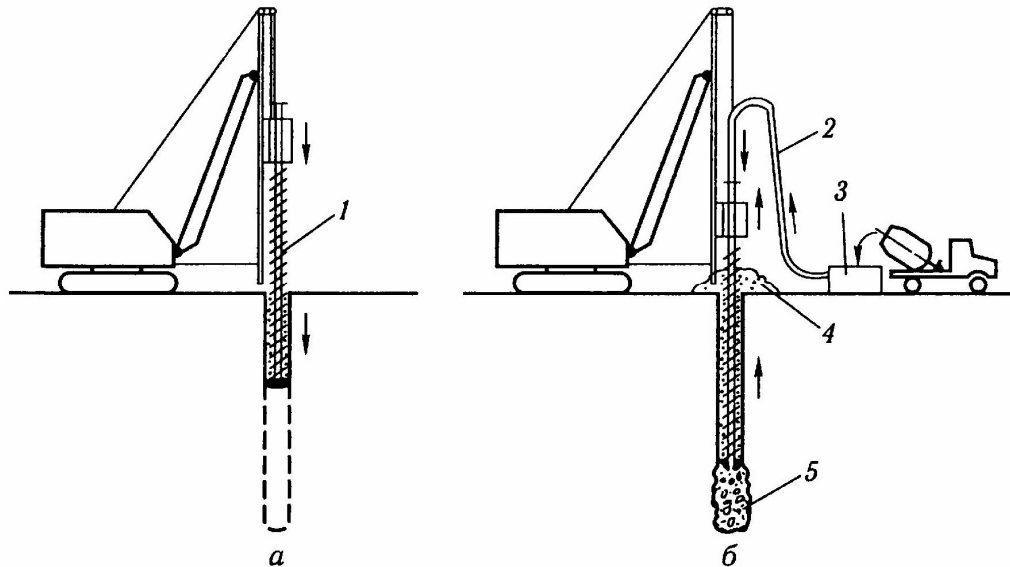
Виготовлення буроін'єкційної палі: а - буріння свердловини шнеком; б - нагнітання бетонної суміші у свердловину через шнек з одночасним підйомом бурової колони; 1 - шнековий бур з бетоноводом; 2 - гнучкий бетонопровід; 3 - бетононасос; 4 - буровий шлам; 5 - бетон палі
